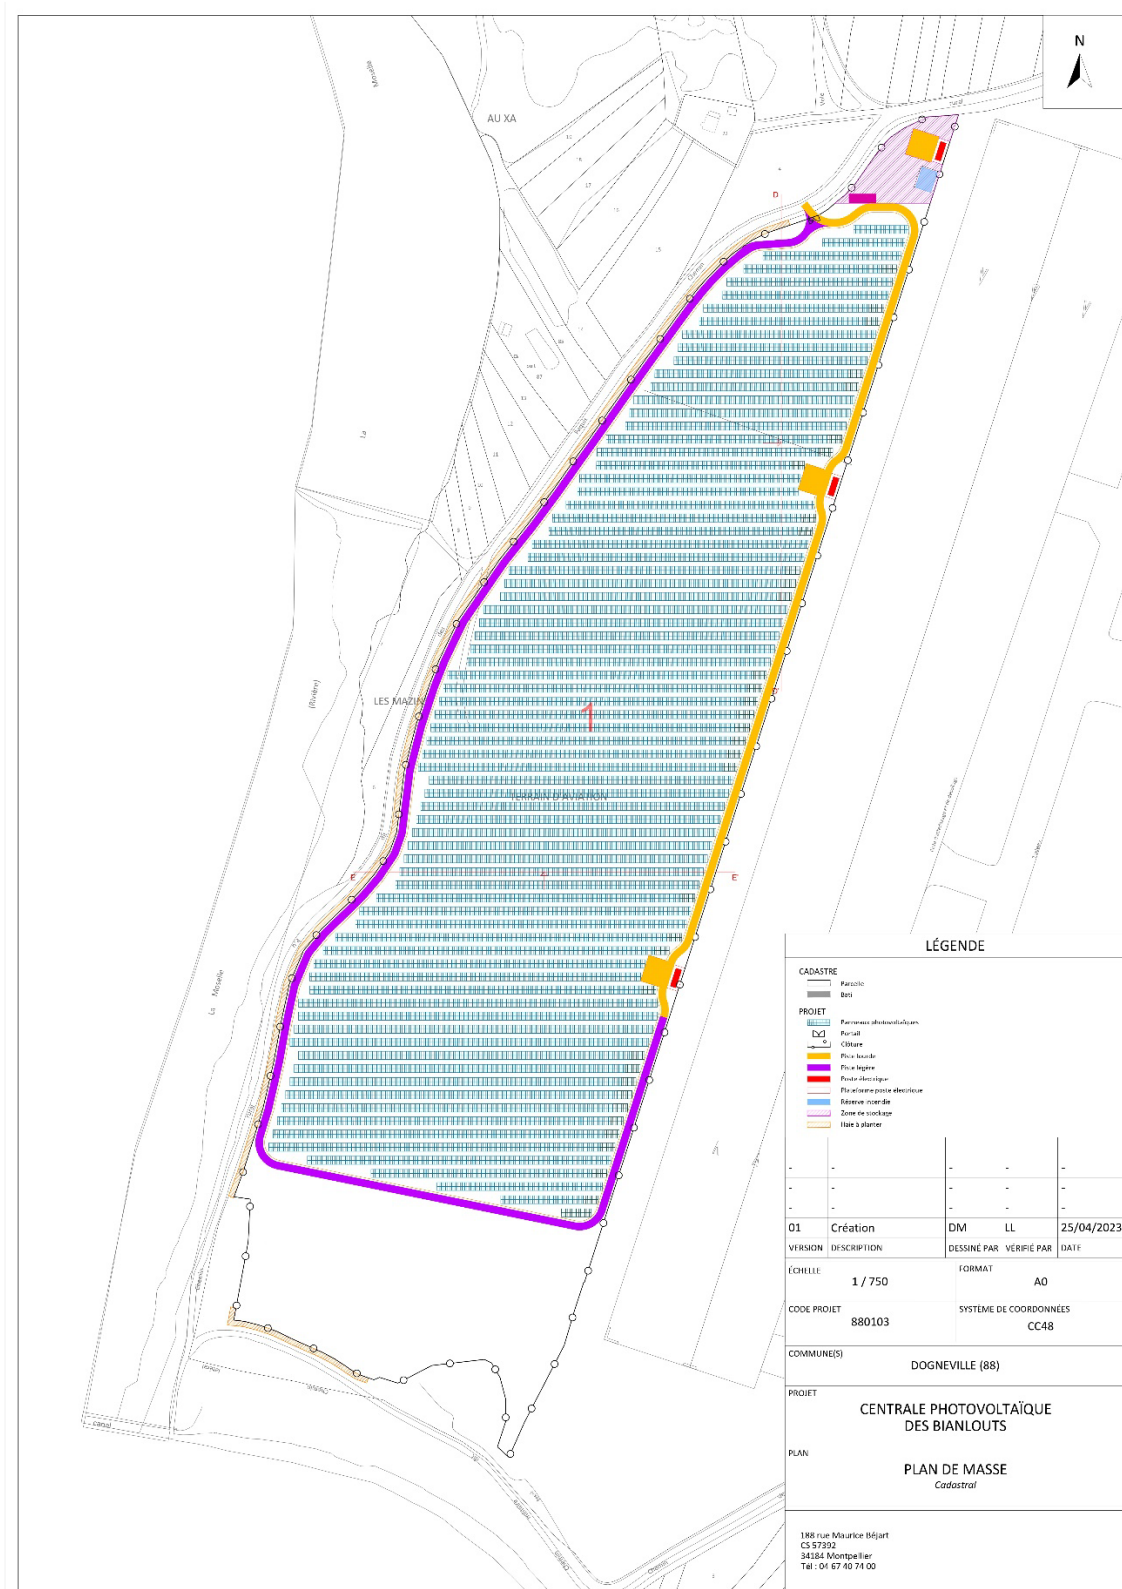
Plan masse d'implantation du projet (source : Valeco)
